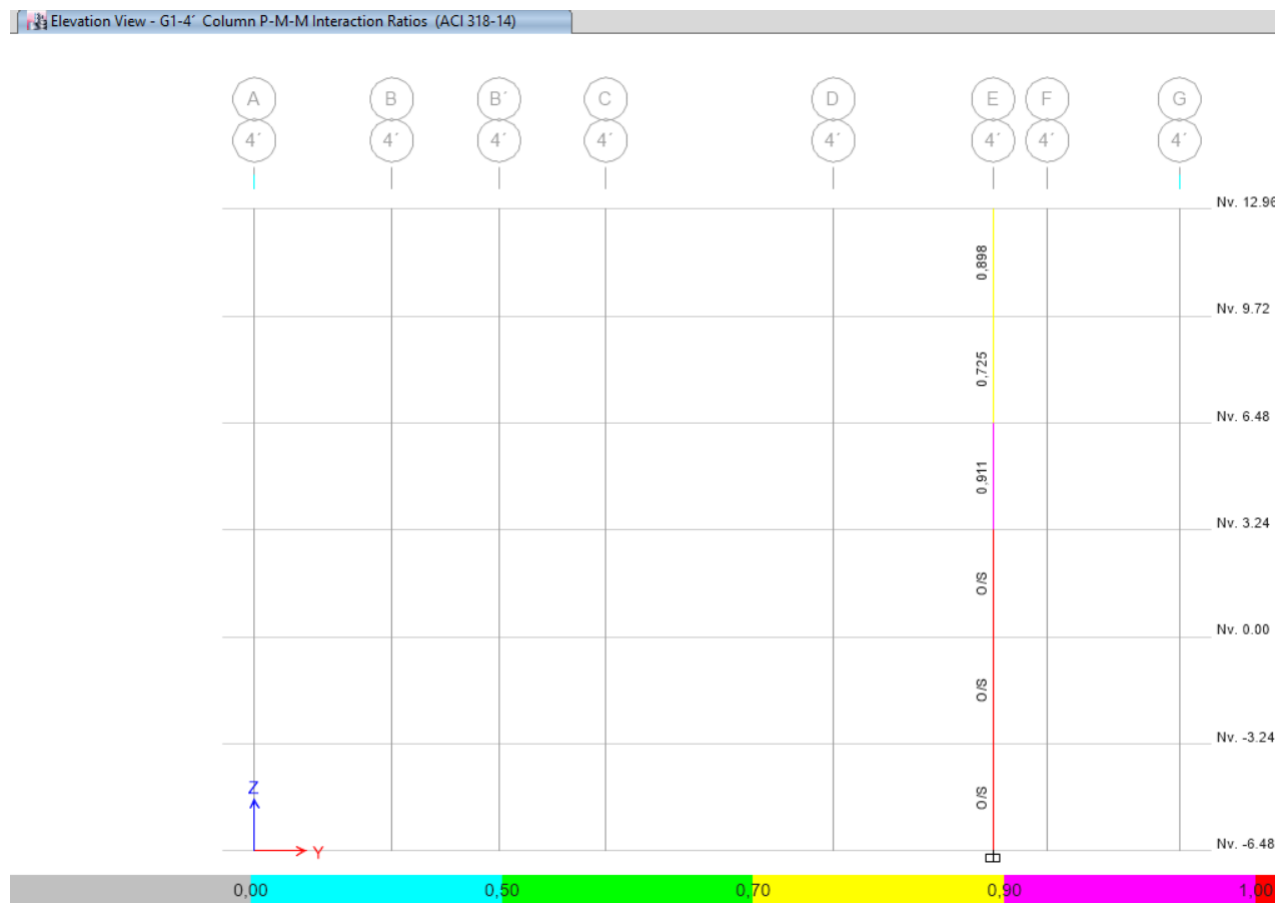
Vista en elevación de la demanda/capacidad en columnas, pórtico eje 4.
